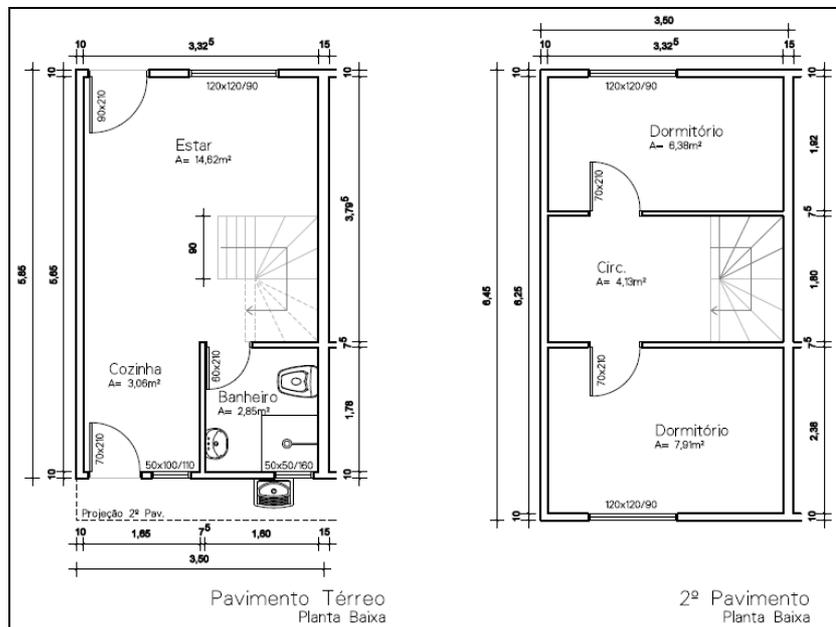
Planta baixa casa 2 pavimentos – Conjunto Habitacional Padre Orestes – 42,80m²
